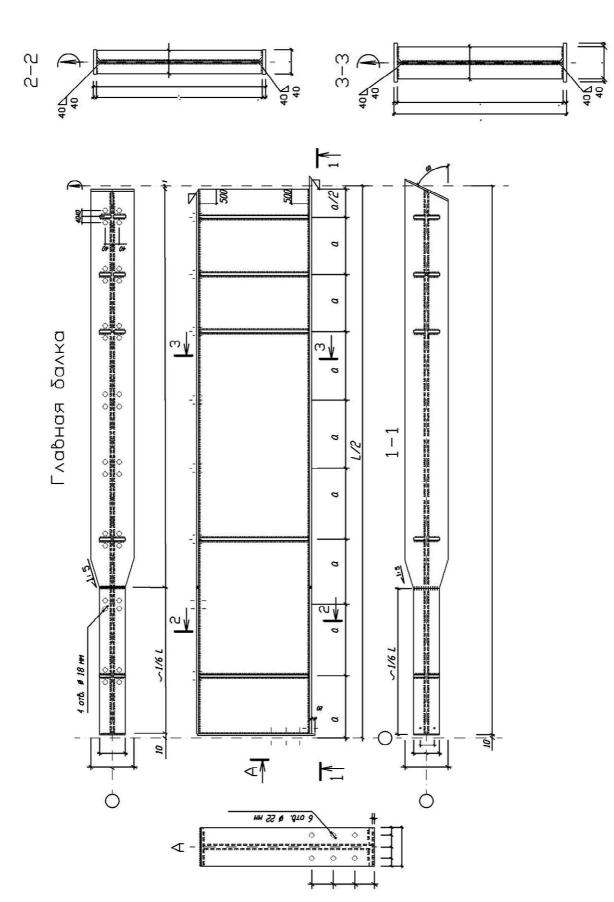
Отправочный элемент ГБ со сварным монтажным стыком при нормальном типе балочной клетки при сопряжении БН и ГБ этажно и опирании главной балки на колонну сверху
